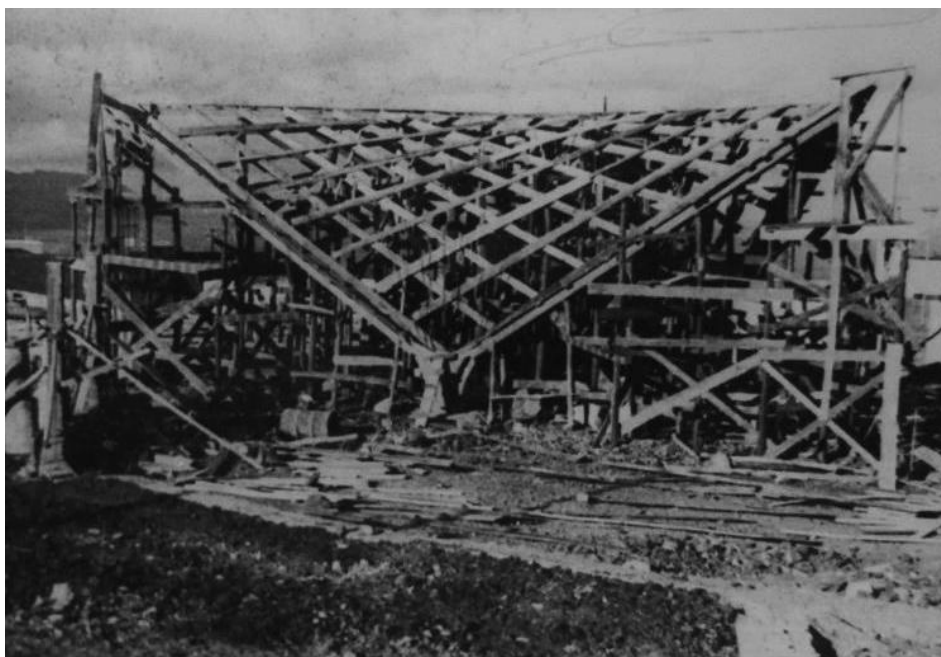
Encofrado lignario para a cubierta. h. 1958
